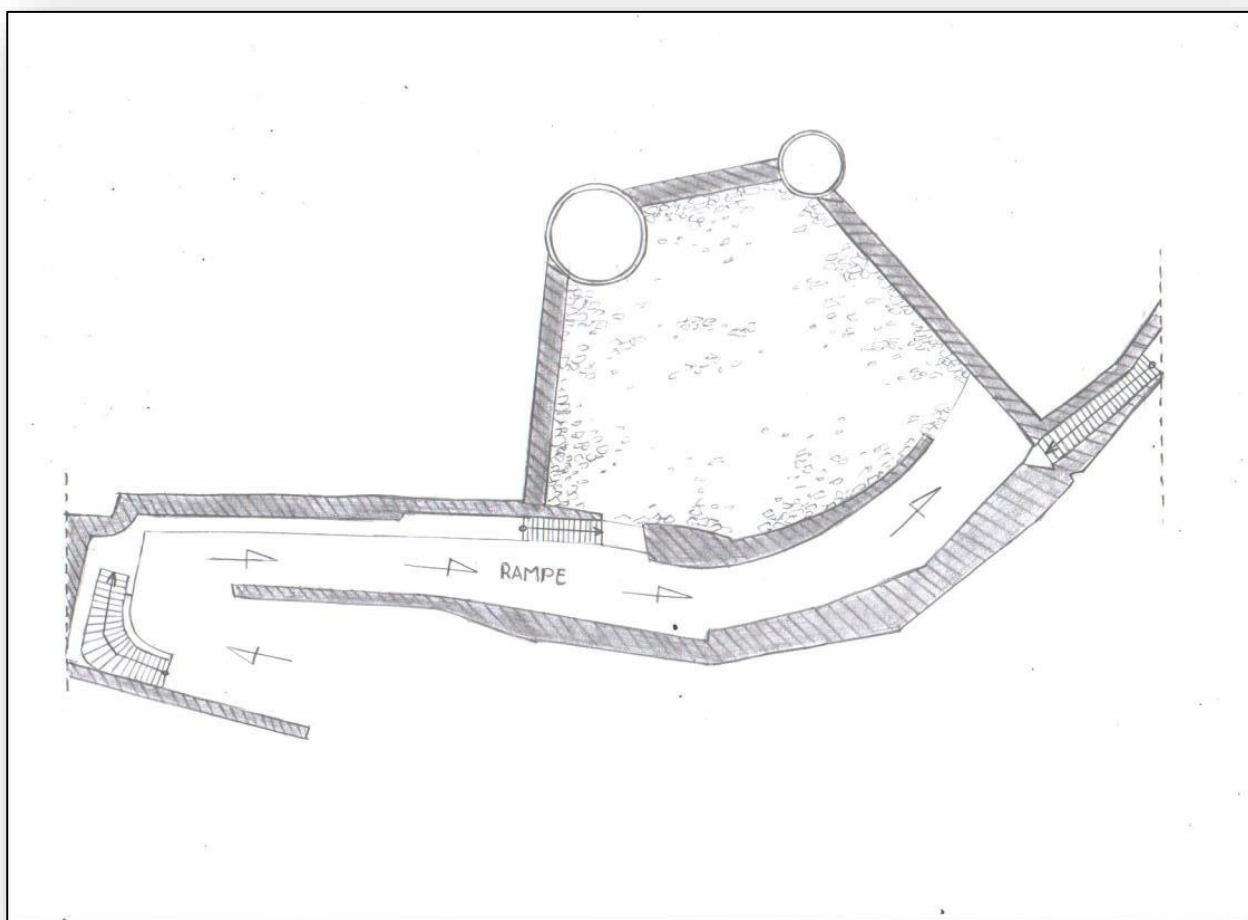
Vue En Plan Des Murailles Nord De La Citadelle.
